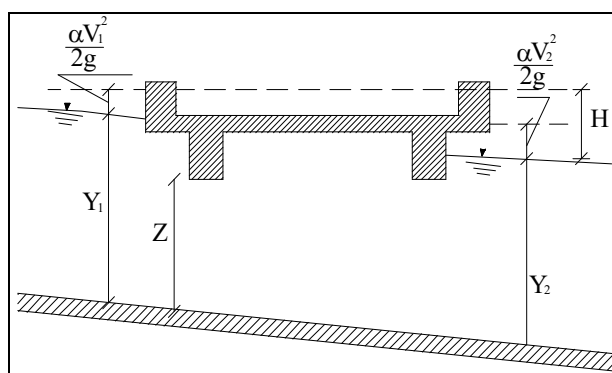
Sezione schematica di un ponte – Schema di calcolo
